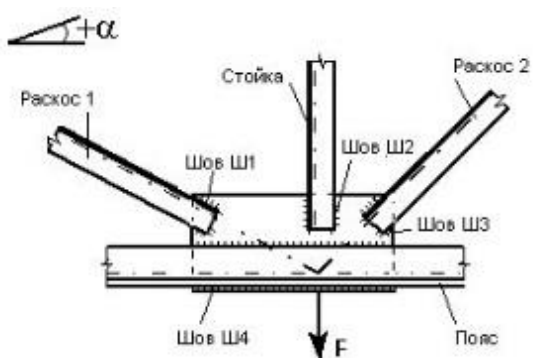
«Конструкторский чертеж узла номер 4» [10]
